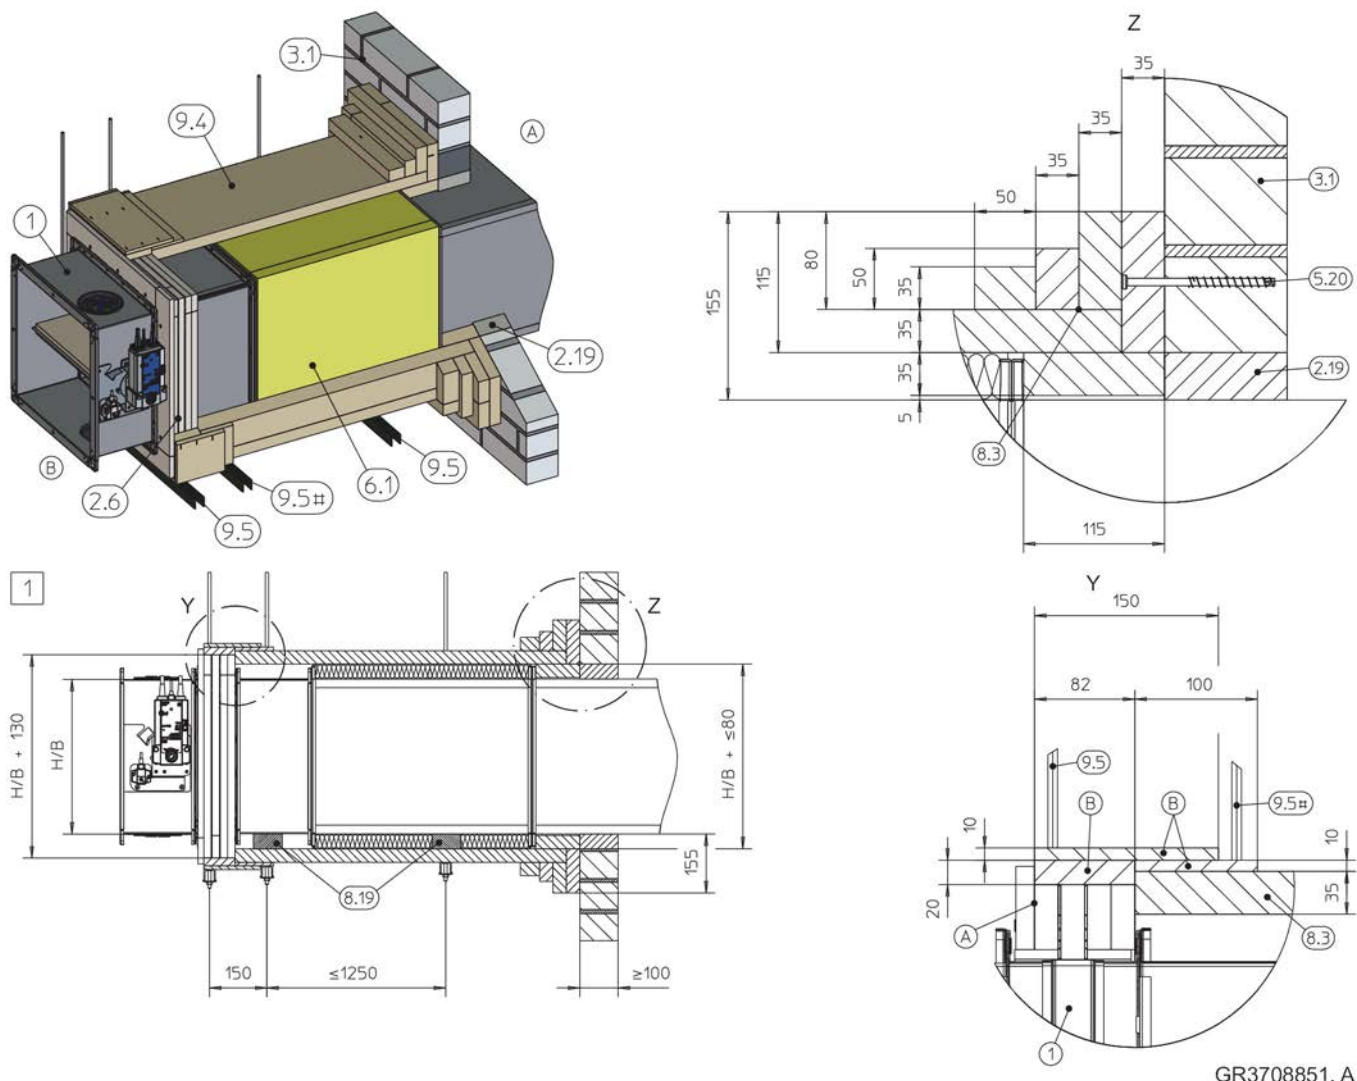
Installazione senza muratura su un muro solido con kit d'installazione WA (tipo con montaggio a parete)
